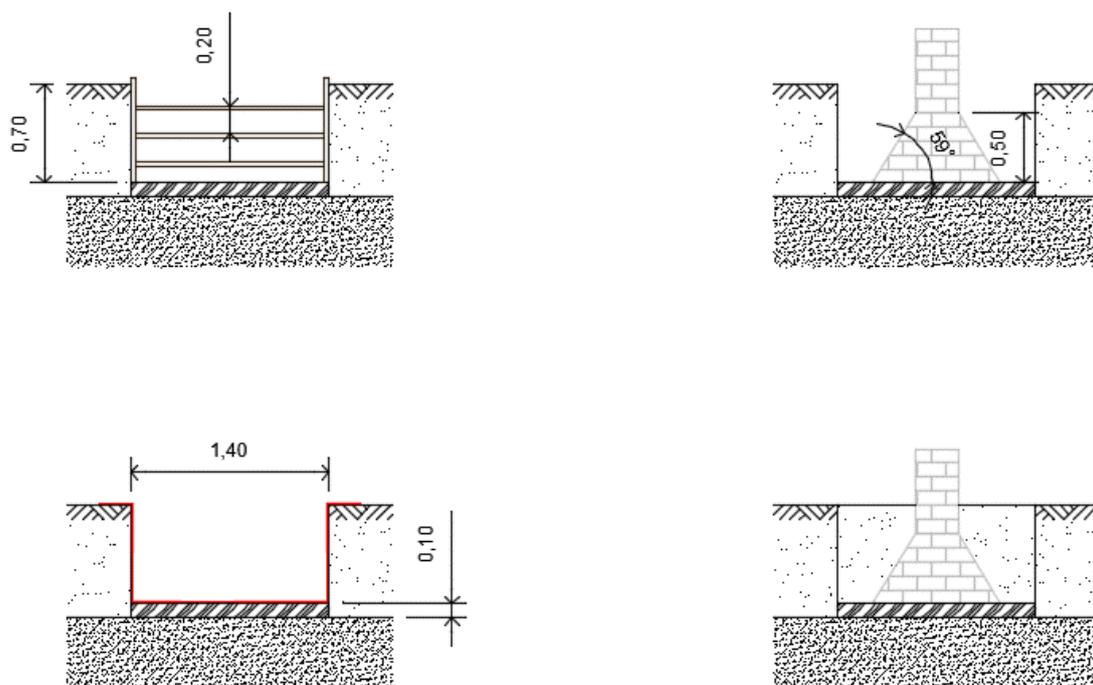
Proceso constructivo de la zapata. Primero se excava hasta el estrato resistente, se coloca la entibación, la cama de arena compactada y se rellena entre zanjas con zahorras. Después se coloca la lámina impermeable y se ejecuta la zapata, para finalmente recubrir los huecos de la excavación con zahorras, allanando el terreno. Año 2016. Elaboración propia.
